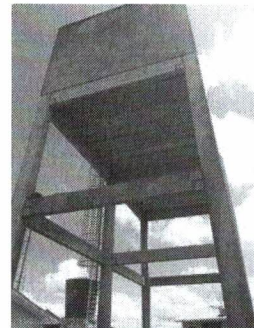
Reservatórios em fibra com estrutura em concreto, elevado
